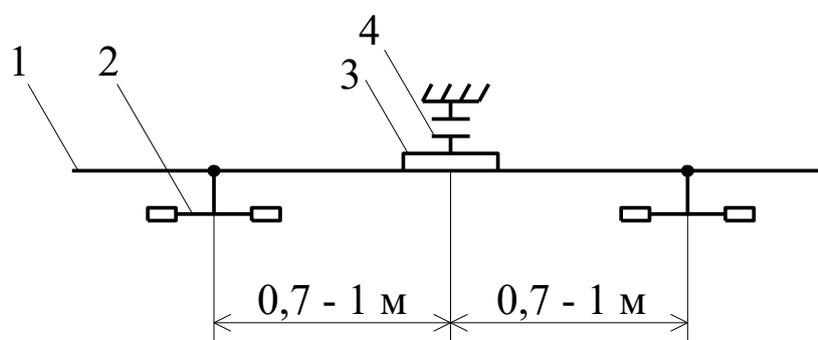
Монтаж рессорного провода в местах крепления на опоре с подвесными изоляторами.
